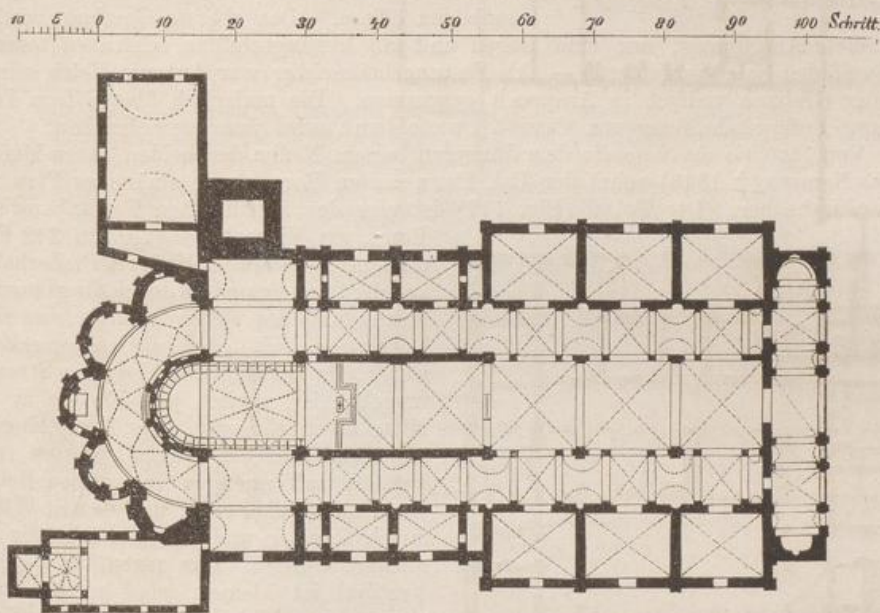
Grundriss der Kirche in S. Benedetto. (M. Lohde.)
